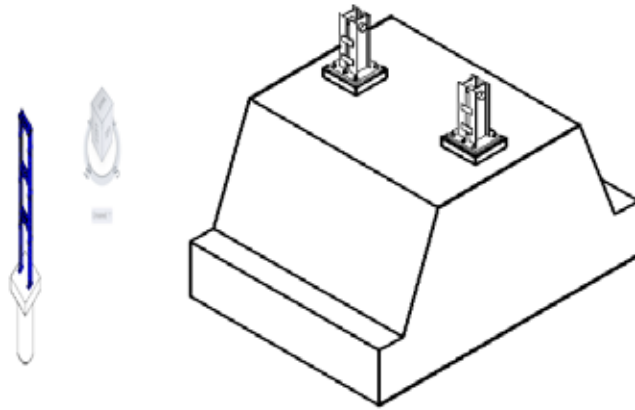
Bekisting pasangan batu untuk pondasi
